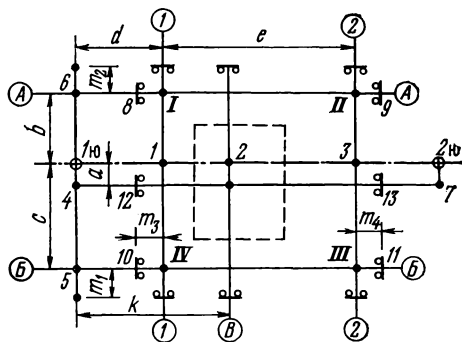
Схема разбивки фундаментов подъемной машины и здания подъема
